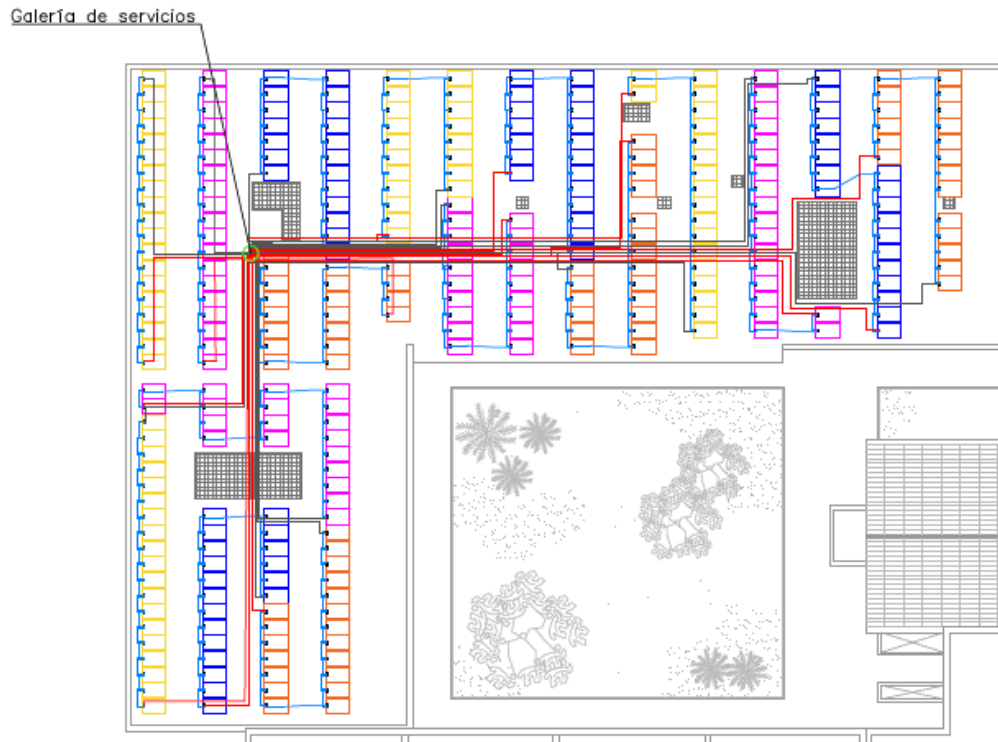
Plano de la distribución del cableado de CC sobre la cubierta.
